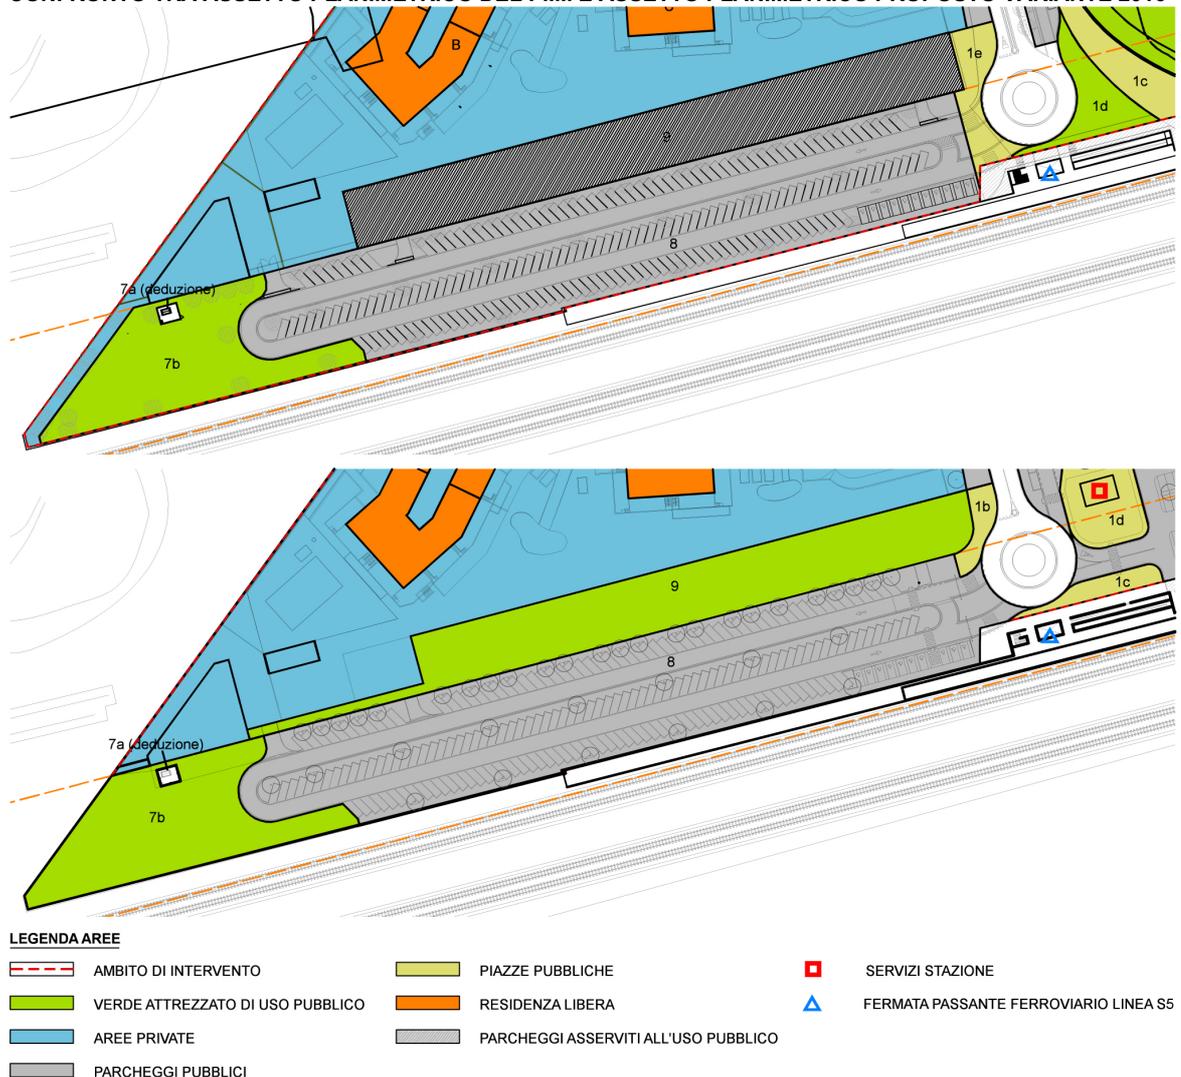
| La destinazione dell'area in oggetto secondo la planimetria di P.I.I. (sopra) e nella variante 2016.
